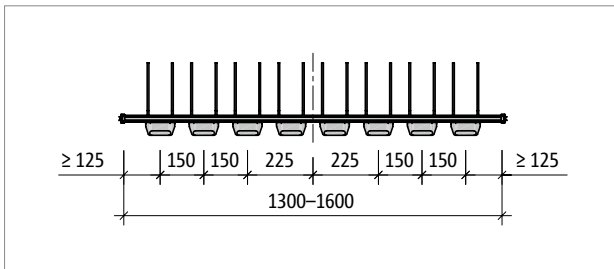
Schöck Tronsole® Typ T-V8-...-L1300 bis L1600: Produktgrundriss
